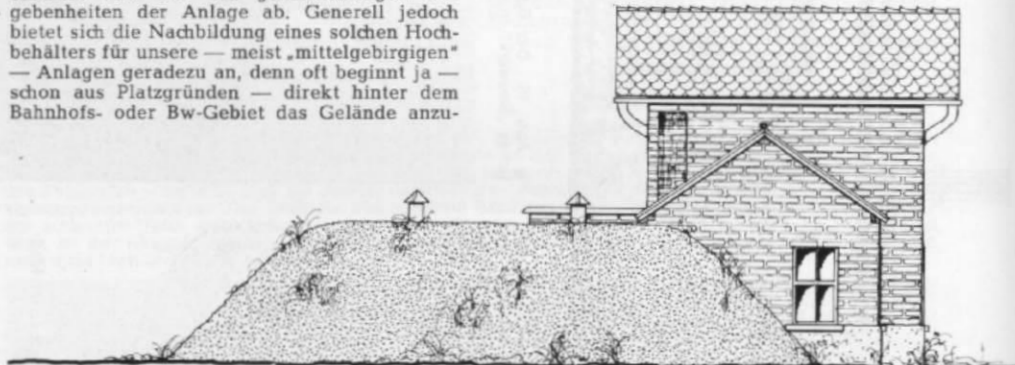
Der in Beton ausgeführte unterirdische Wasserbehälter von Buchholz, der unmittelbar neben dem hochliegenden Maschinenhaus eingebaut ist. Wer einen derartigen Behälter nachbildet, kann natürlich den Baustil des Maschinenhauses den übrigen Gebäuden seiner Anlage anpassen (Zeichnung in  $\frac{1}{2}$  H0-Größe).
